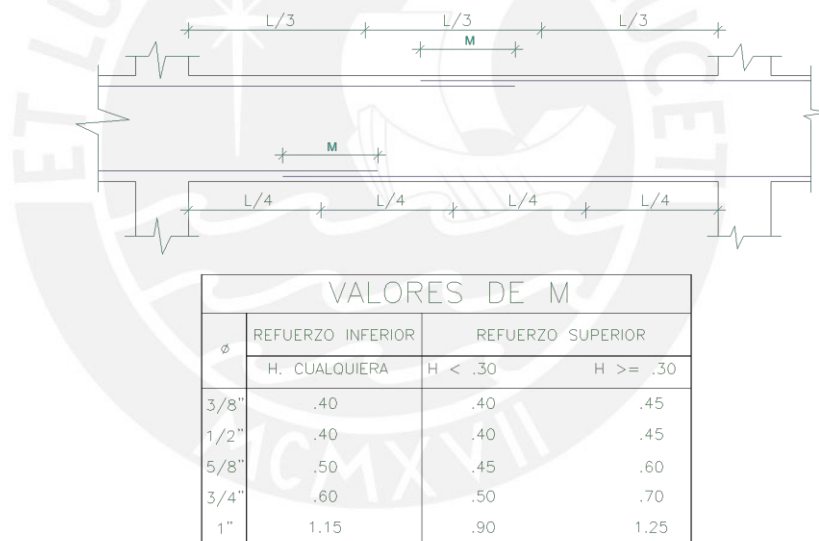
TRASLAPES EN VIGAS Y ALIGERADOS.
